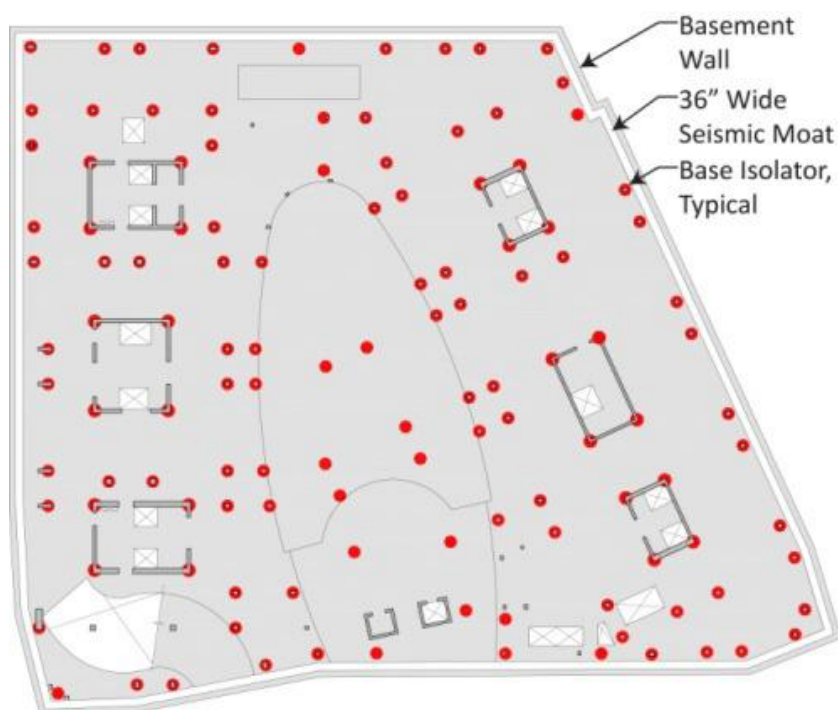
Distribución de aisladores FPS en una edificación que tiene muros y columnas (Sarkisian, Lee, Long, Shook, & Díaz, 2013)
